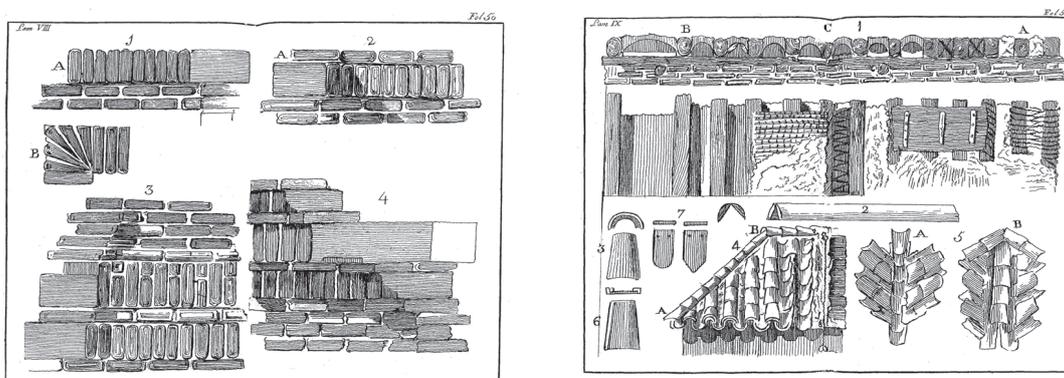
Construcción de muros de ladrillo y cubiertas, *Arte de Albañilería*, 1827.
